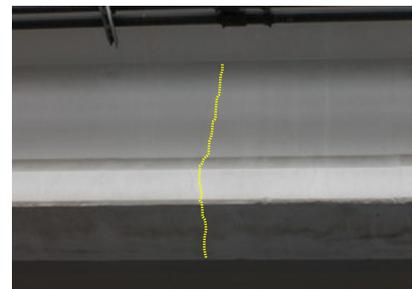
スターラップのかぶり不足による鉛直ひび割れの例
